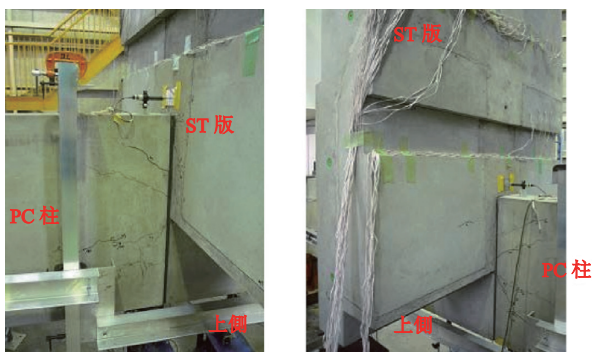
No.2 正曲げ試験体 $R=1/75$ 状態ひび割れ状況
